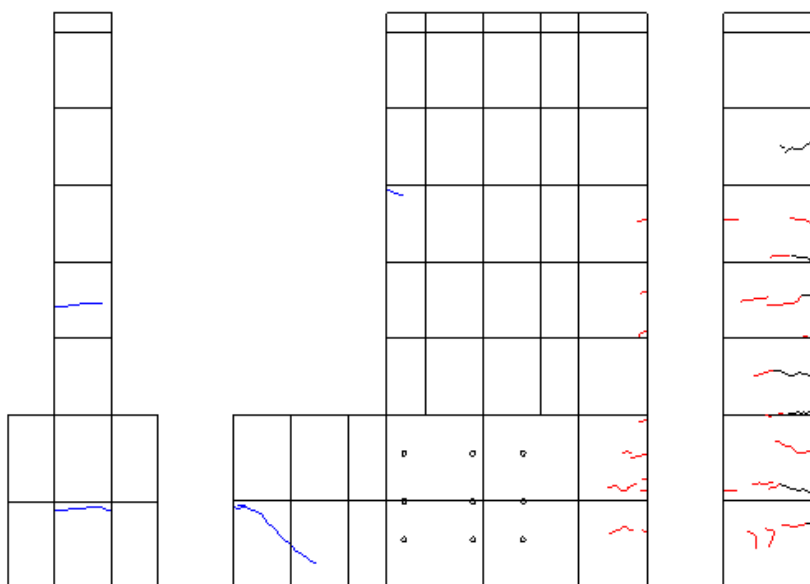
R=1/400 ひび割れ図
